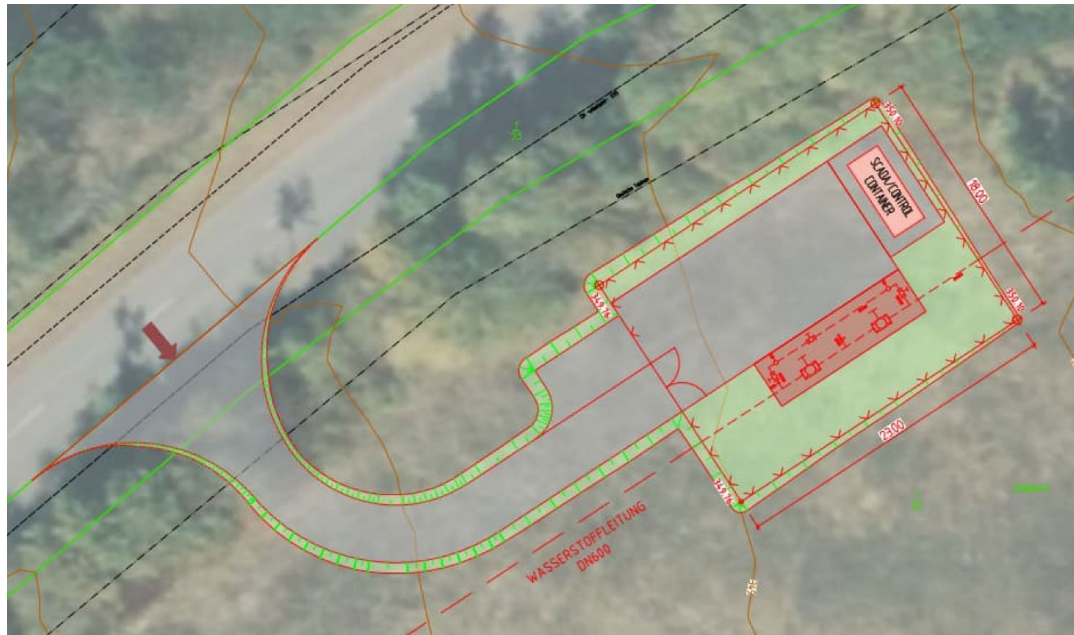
Standort Armaturenstation Kerlingen-Oberlimberg
